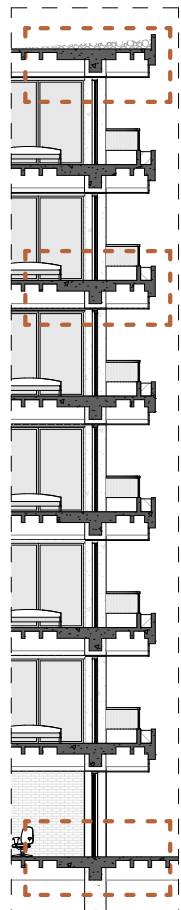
Detalle constructivo Escala 1:20 ENTREPISO Fuente: Elaboración Propia 2026
